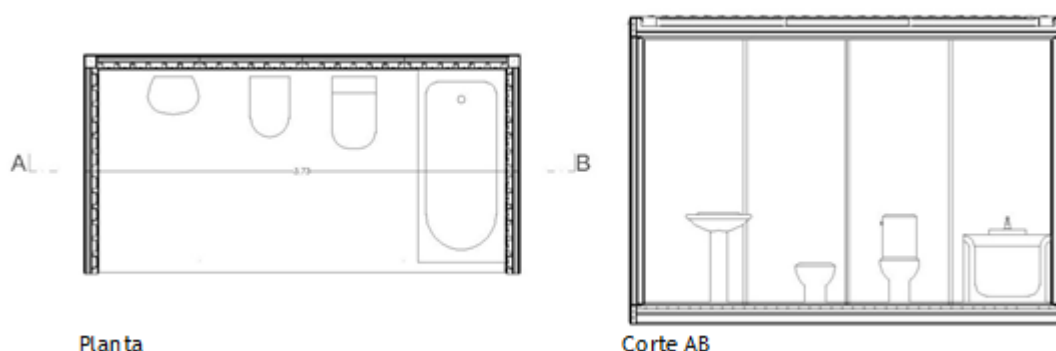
Instalação sanitária. Planta e corte AB.
